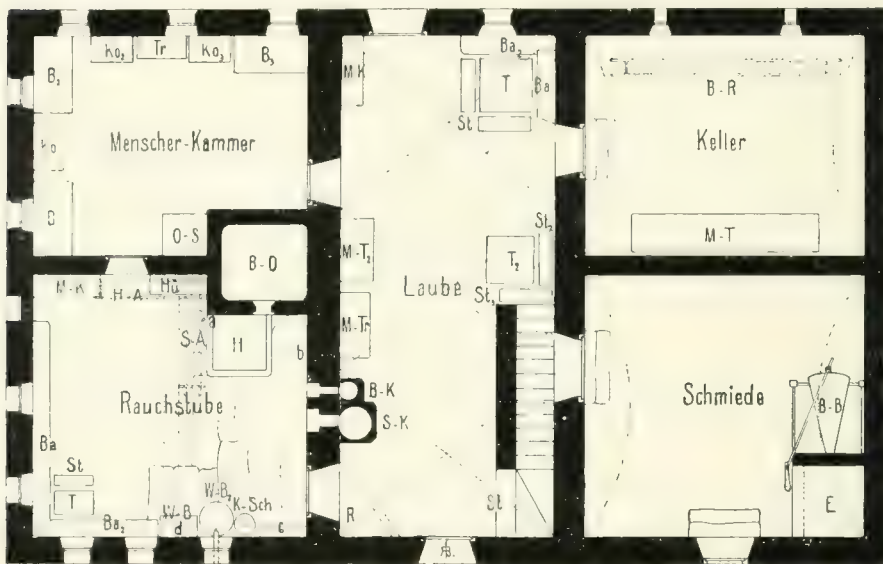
Grundriß des Hofameser-Hauses. 1:100.
